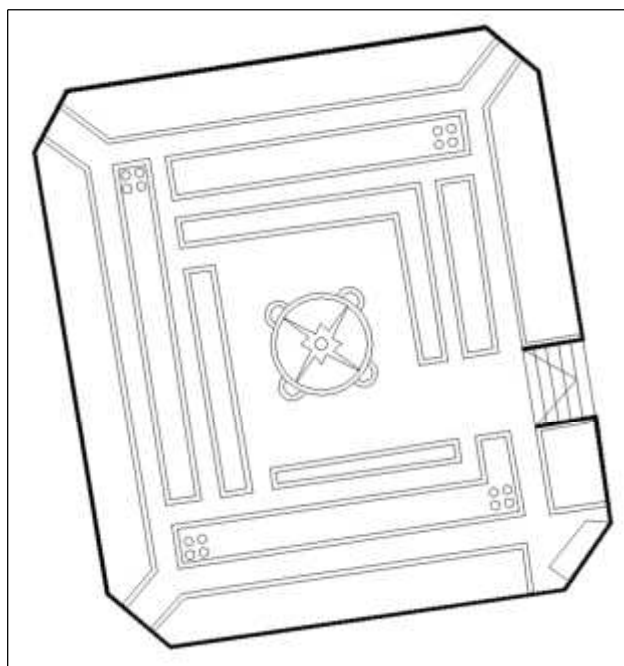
Plan Migge 1913, Ausschnitt Brunnenhof (Nachzeichnung)
